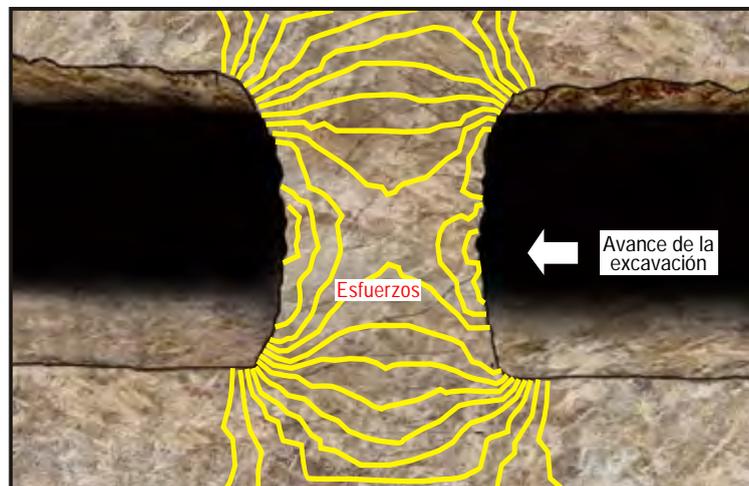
Concentración de los esfuerzos en el pilar que puede llevar a su fallamiento.
